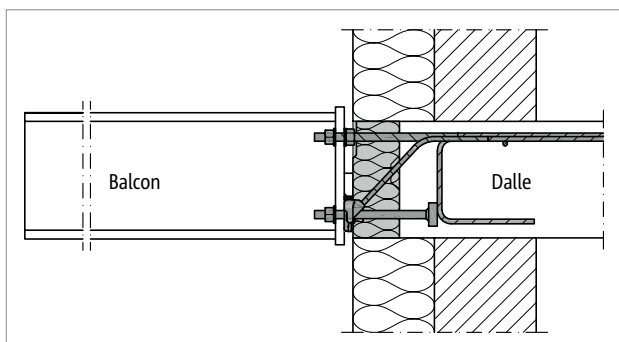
Schöck Isokorb® T type SK : Le corps isolant affleure le nu extérieur de l'isolation du mur grâce à la saillie de la dalle vers l'extérieur. Ce faisant, les distances aux bords latéraux doivent être respectées
